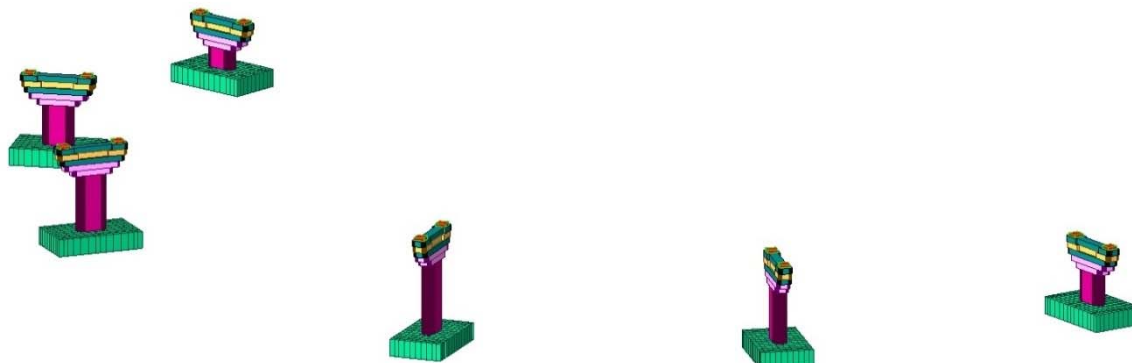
Vista Pile – Sovrappasso di Ingresso
